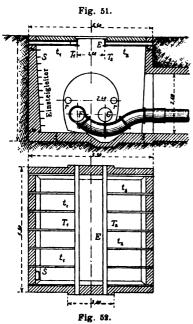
Querschnitt, Fig. 52. Grundriss einer Förderkammer der Dampf- und Wasserleitung.
